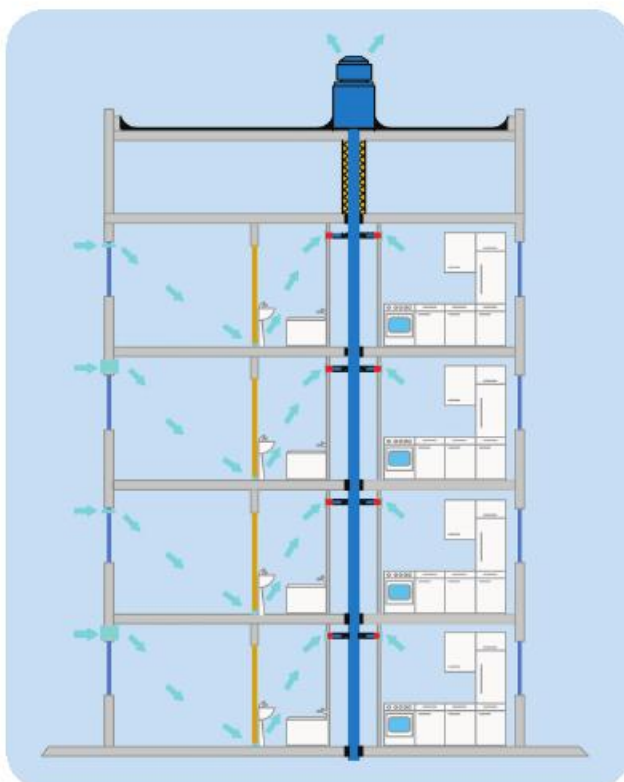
Схема механической вытяжки с установкой крышного вентилятора
